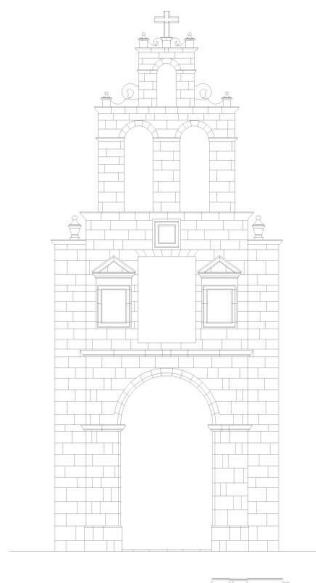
Levantamiento de plano alzado. Realizado en 2013.
